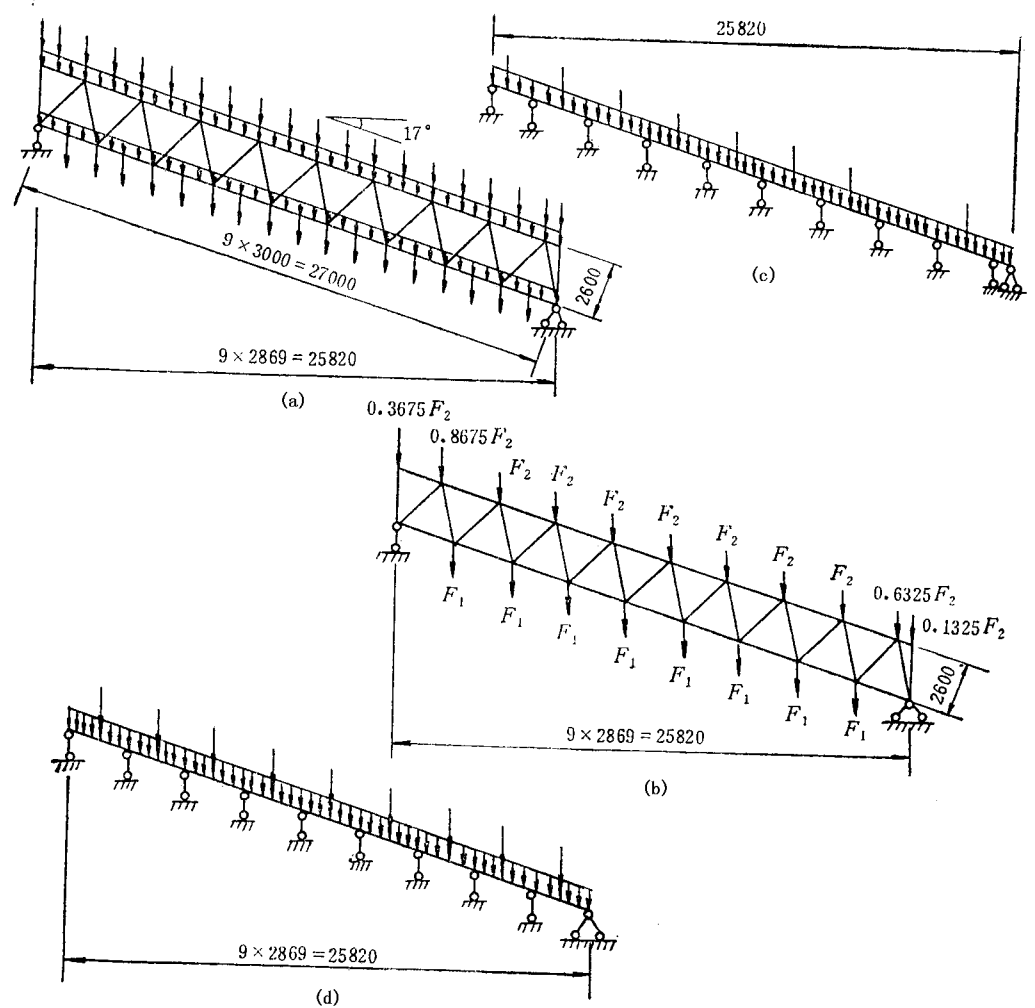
预应力钢筋混凝土平行弦桁架计算简图
